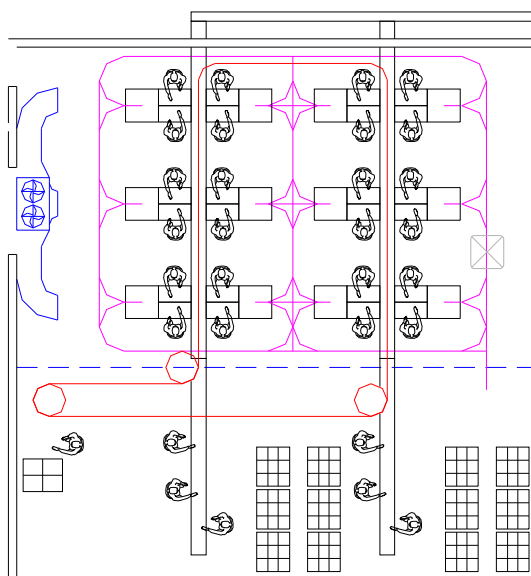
Vista en planta de un módulo de pelado con abastecimiento continuo y sala de envasado
